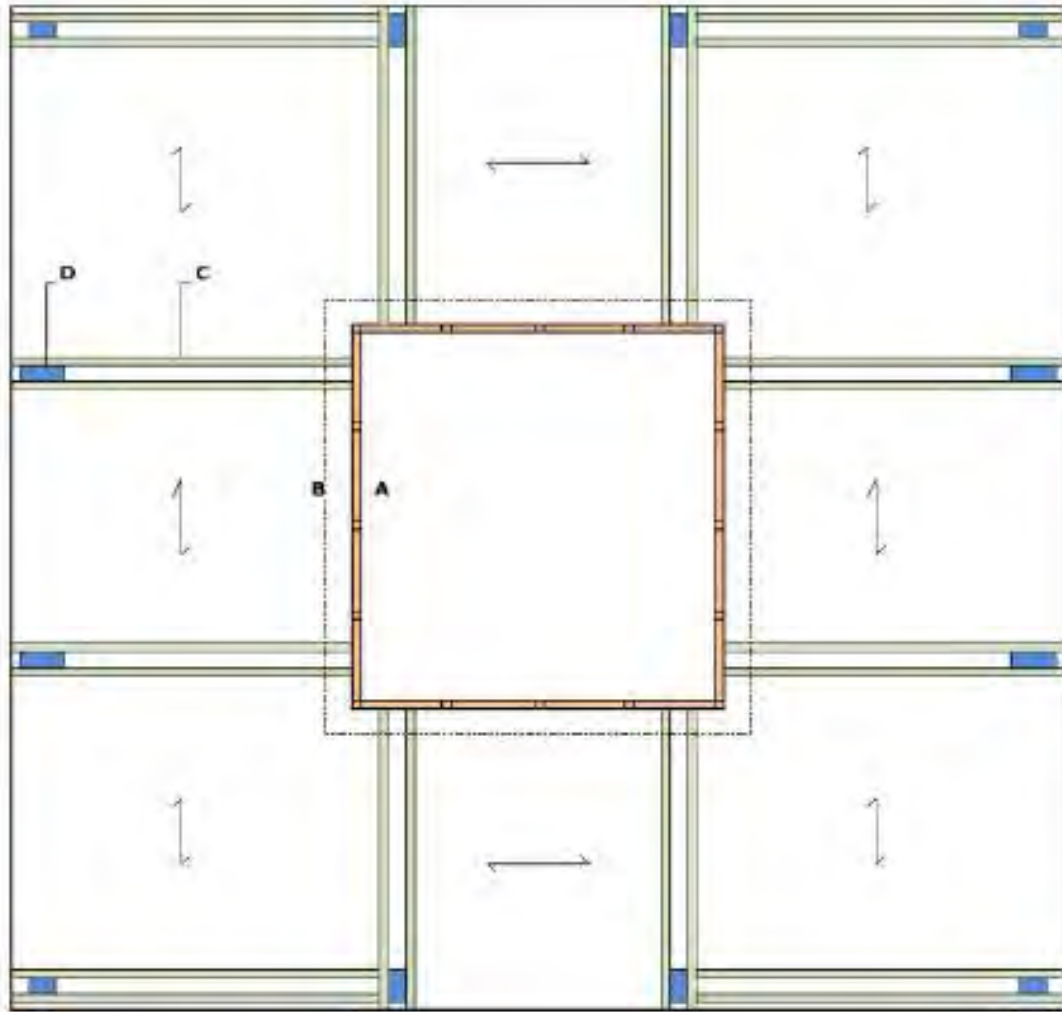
Pianta dell'edificio-studio. Immagine tratta da "Integrating cross-laminated timber panels to construct buildings to twenty levels" John Chapman.
